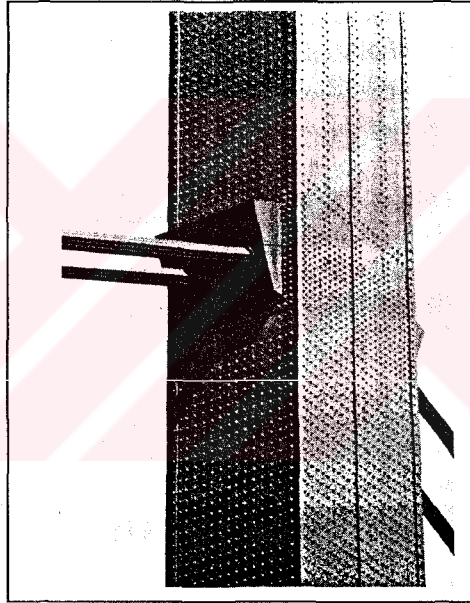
Dames Point Köprüsü için önerilen betonarme kule.
